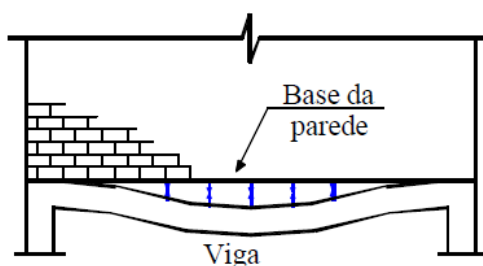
Edificação em alvenaria estrutural sobre pilotis em concreto armado.
